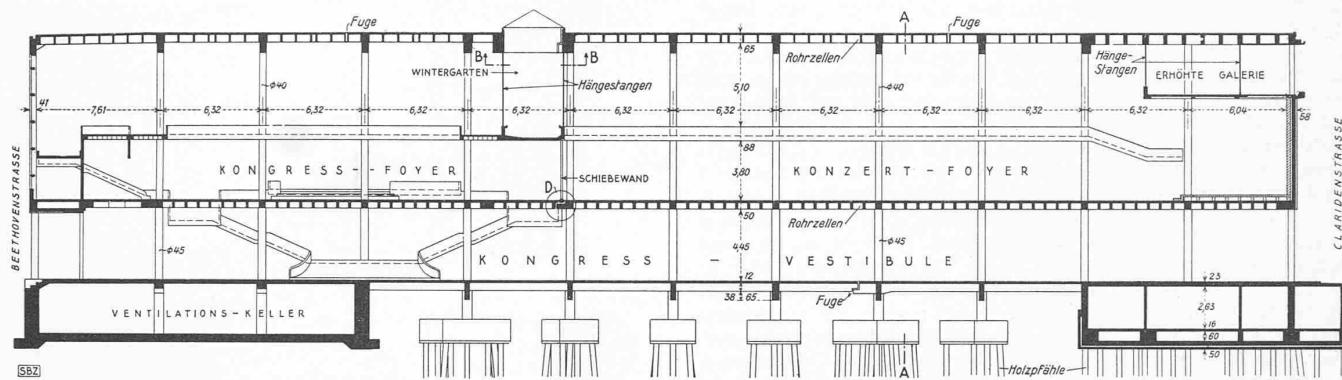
Längsschnitt 1 : 400 durch den Foyertrakt. Eisenbetonkonstruktion von Ing. P. SOUTTER, Zürich
